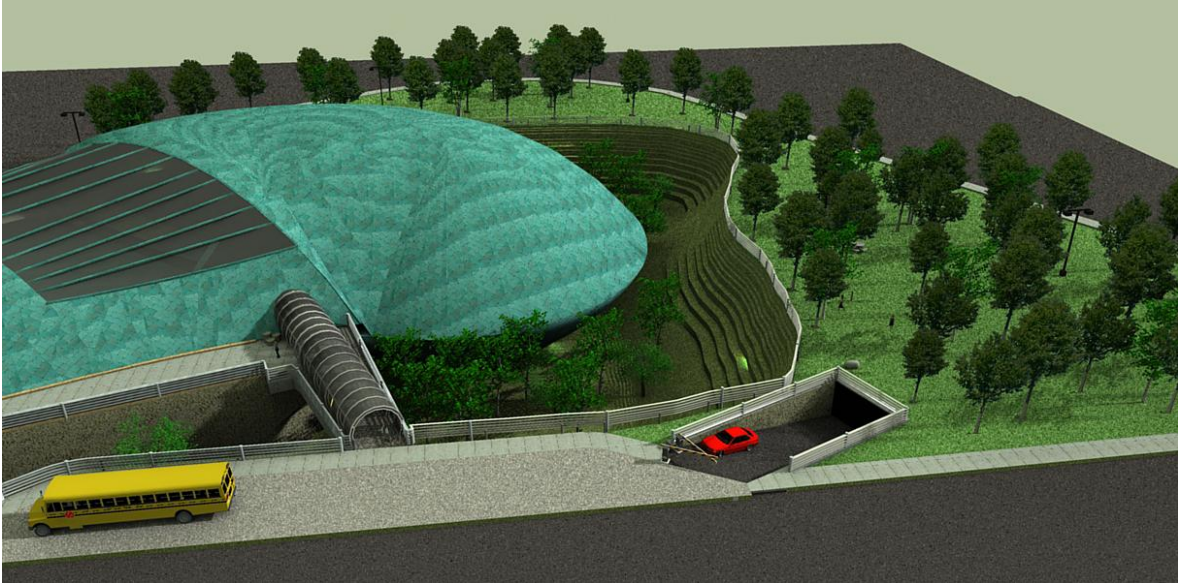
Vista de la fachada norte, con acceso a estacionamiento subterráneo.
